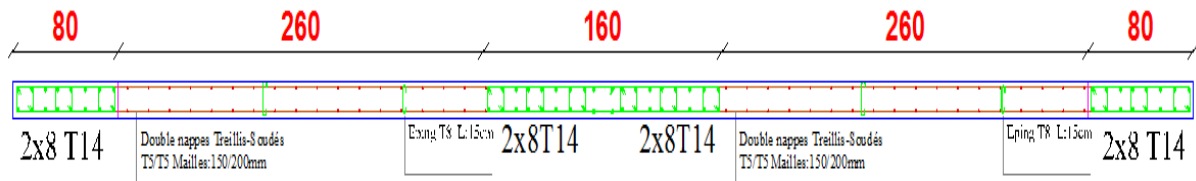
Coupe ferrailage d'un voile VY1.
